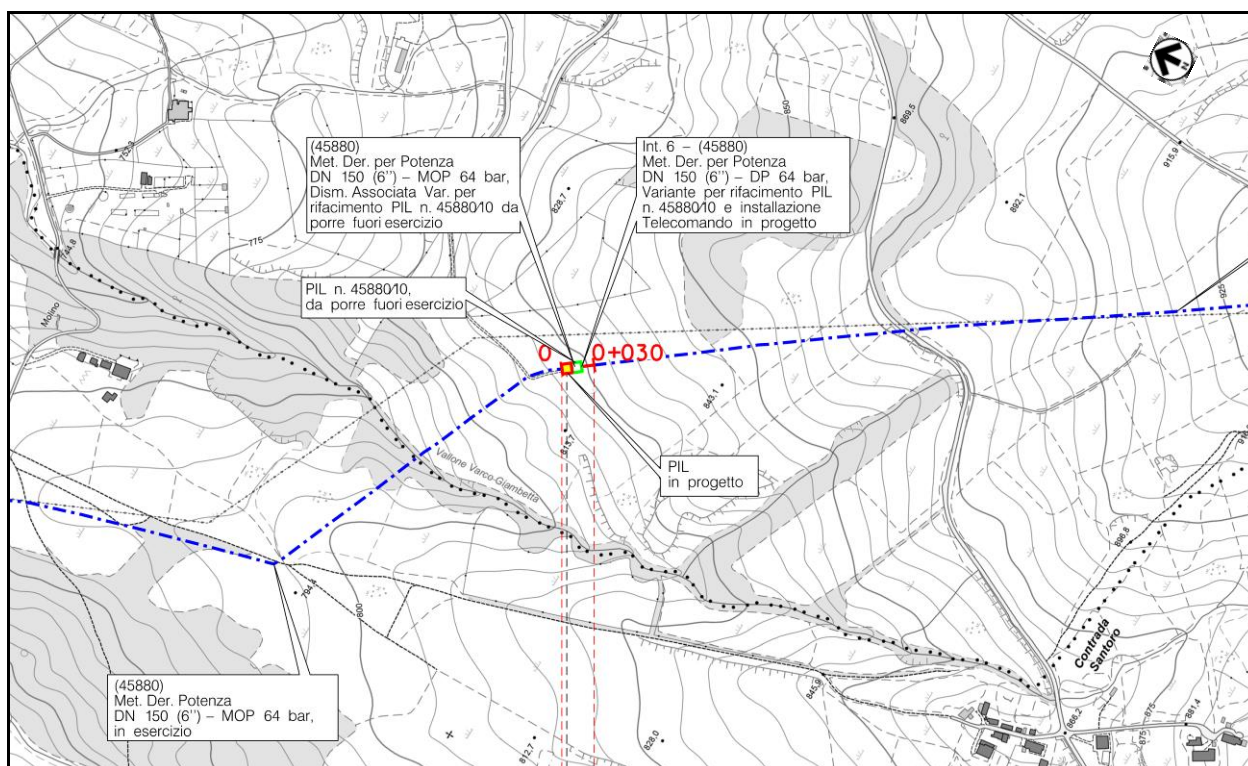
/F.b – Planimetria 1:5.000 con localizzazione dell'area dell'Intervento n.6 (progetto in rosso, dismissione in verde, esistente in blu)
